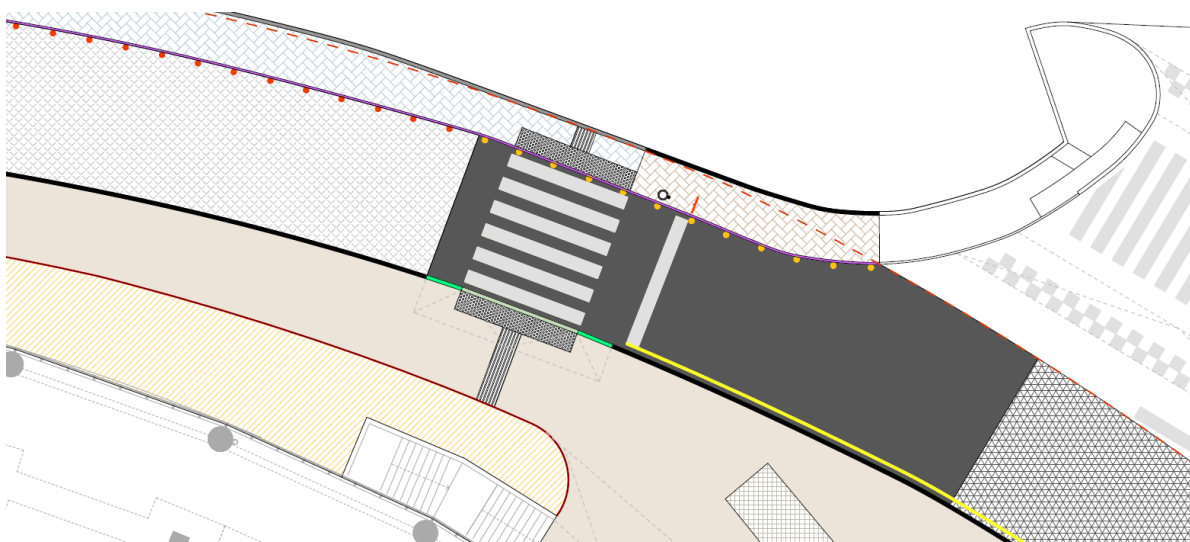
Parcela da Planta de Pavimentos e Revestimentos de Solo
